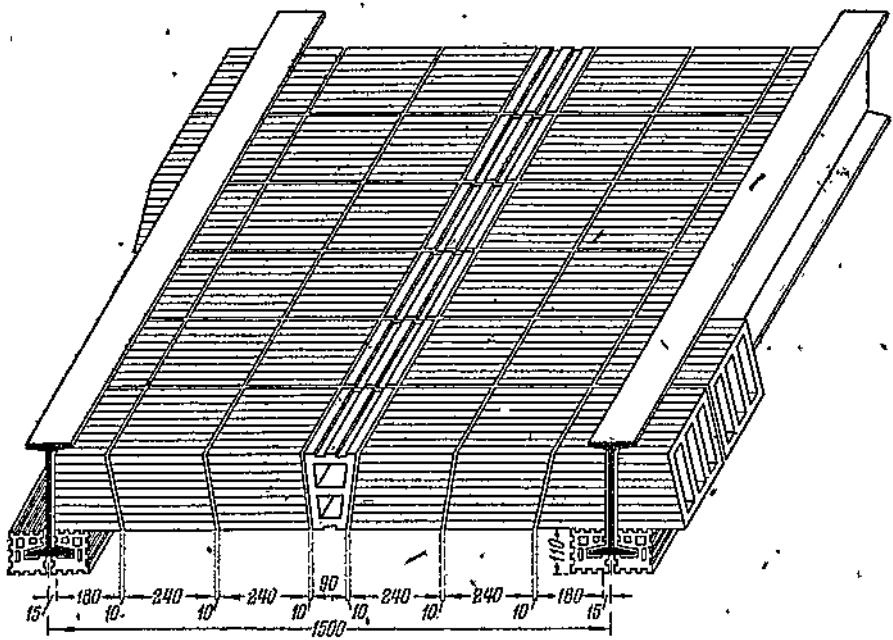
Междуэтажное перекрытие Моспромпроекта с плоским потолком.
